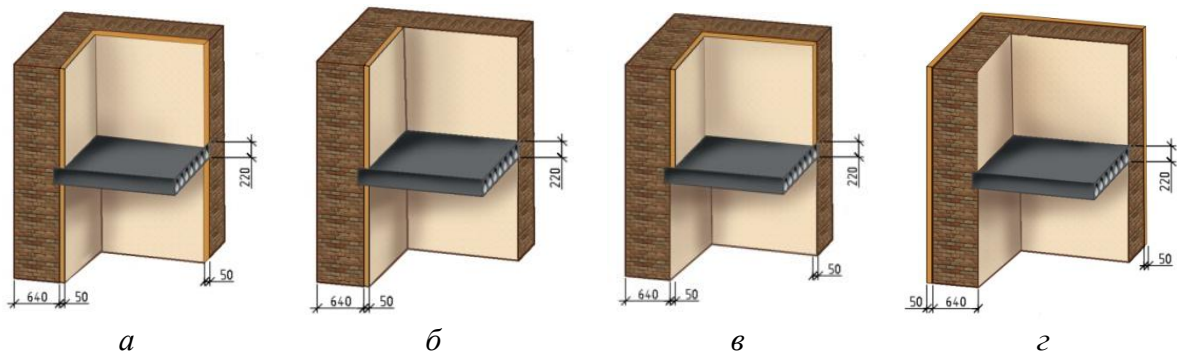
Способы утепления стен: *а* – утепление стен на всех этажах изнутри; *б* – утепление стен по одной из сторон на всех этажах изнутри; *в* – утепление стен на одном из этажей изнутри; *г* – утепление всех стен по наружной поверхности
